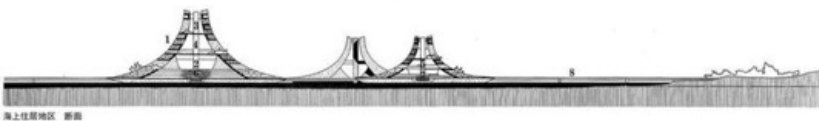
Kenzo Tange, Sezione particolare del progetto di Tokyo Bay, 1960.
